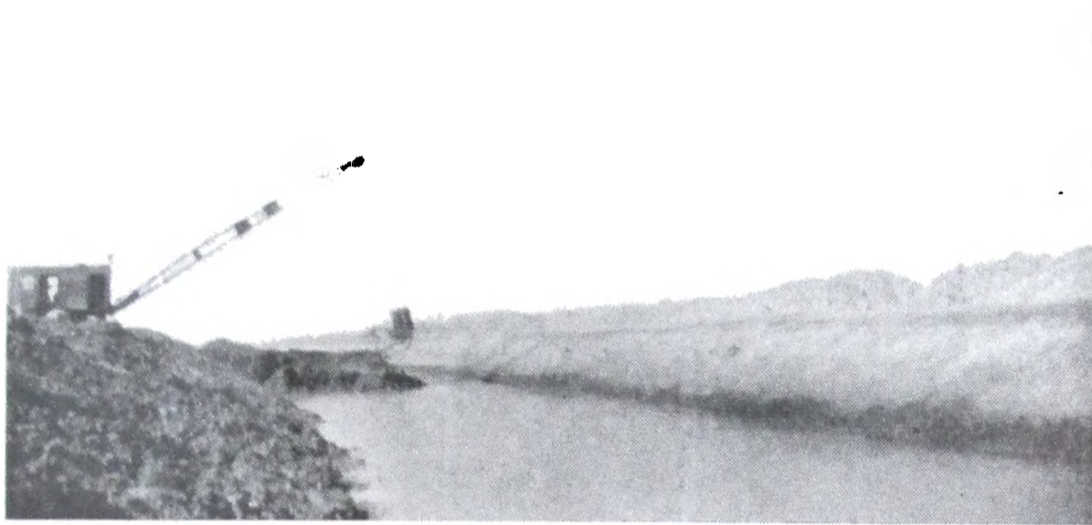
Plan de obras de Castelli. Canal Principal. Vista de un trecho en ejecución, actualmente totalmente terminado.
